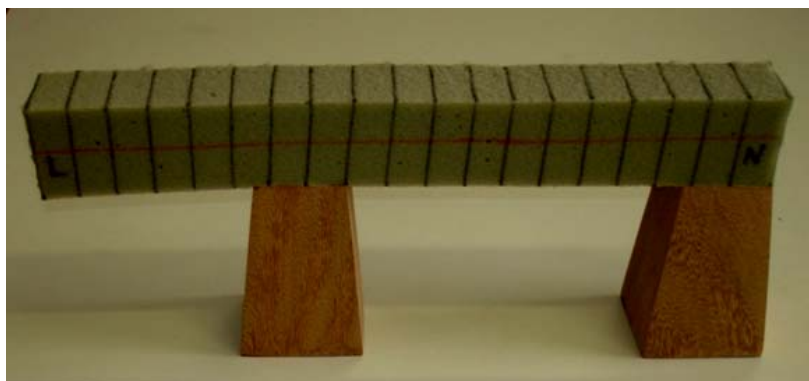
Modelo em espuma de viga com trecho biapoiado e outro em balanço.
